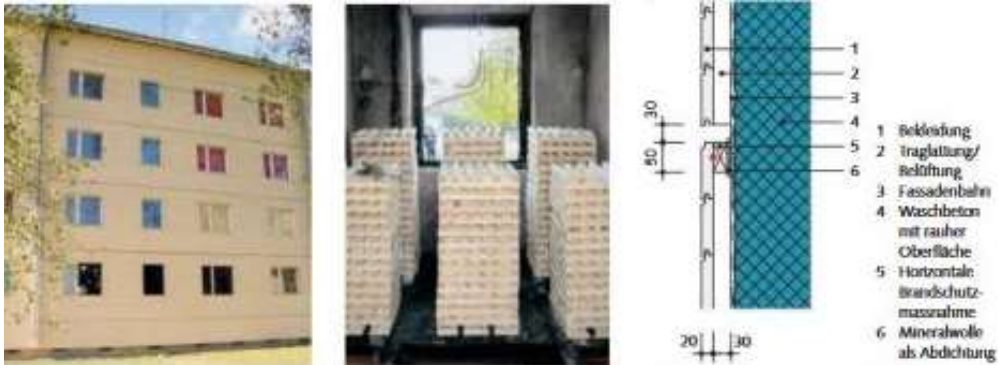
(li.): Fassade vor dem Brandversuch [4]
